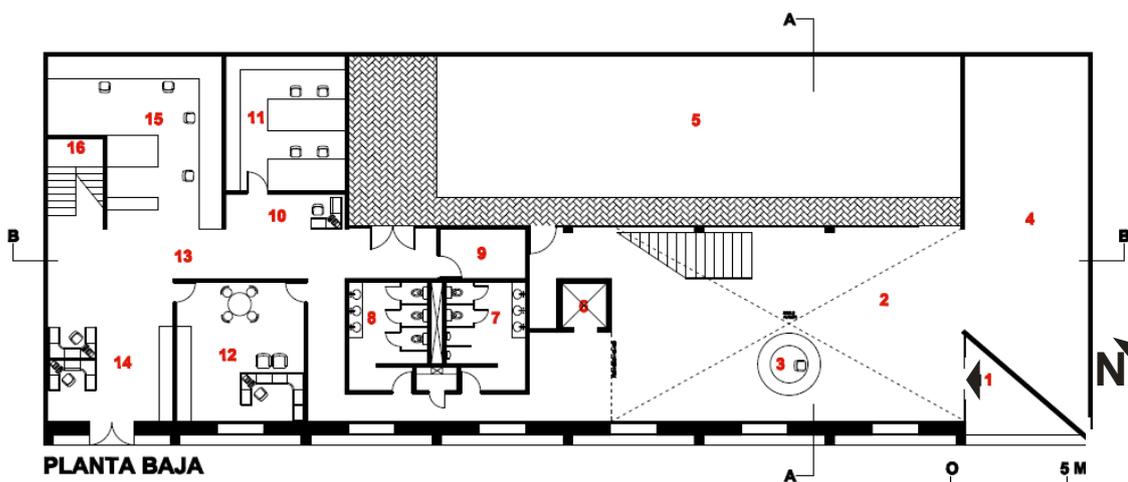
Partido arquitectónico opción "A". Planta baja.
